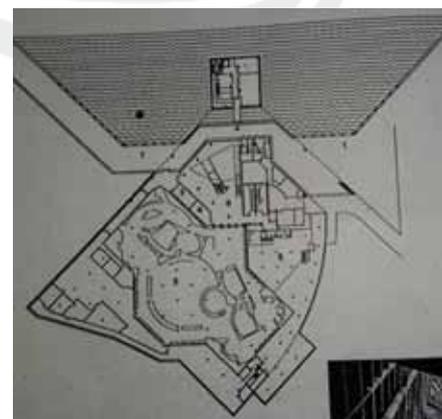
Site Plan The Rock and Roll Hall of Fame and Museum
